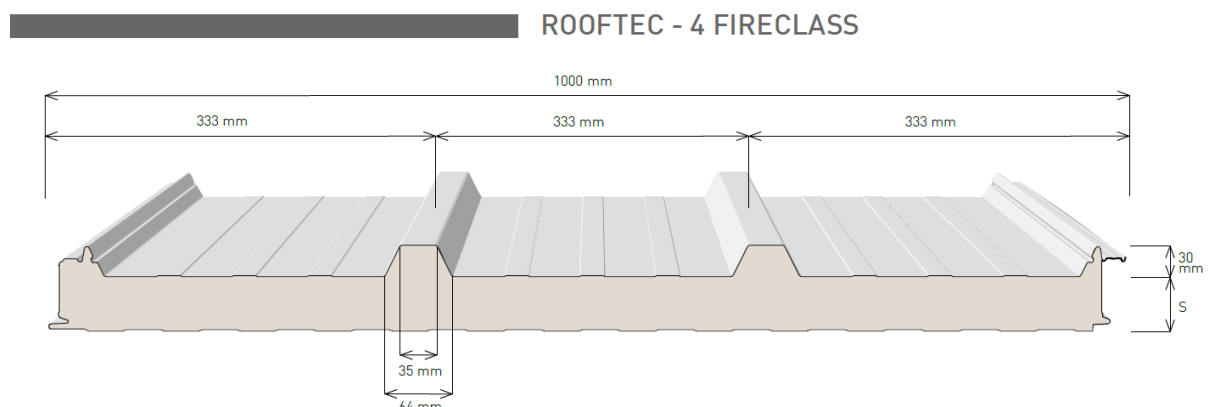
Painéis de ROOFTEC - 4 FIRECLASS.(PERFITEC, 2020)
